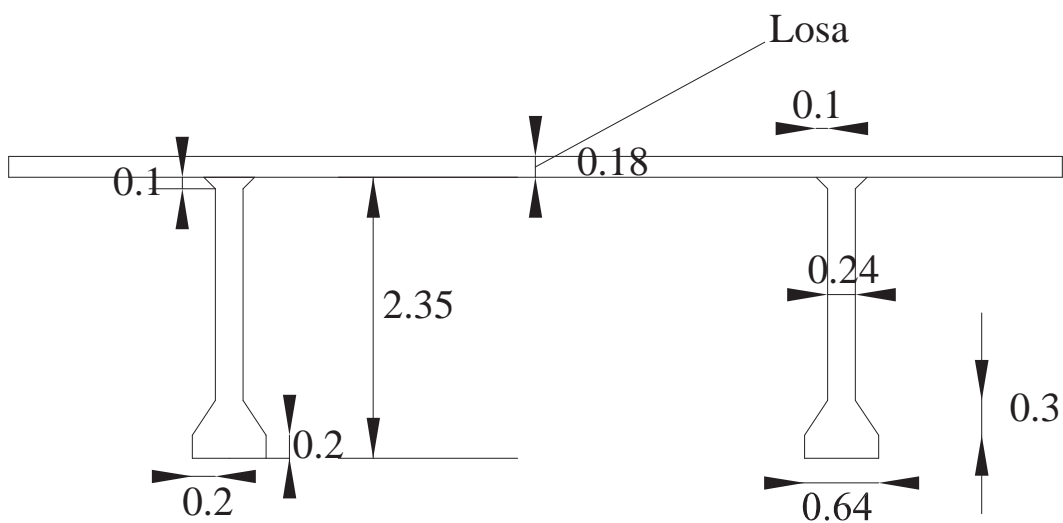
Detalle del sistema de piso (cotas en metros)
